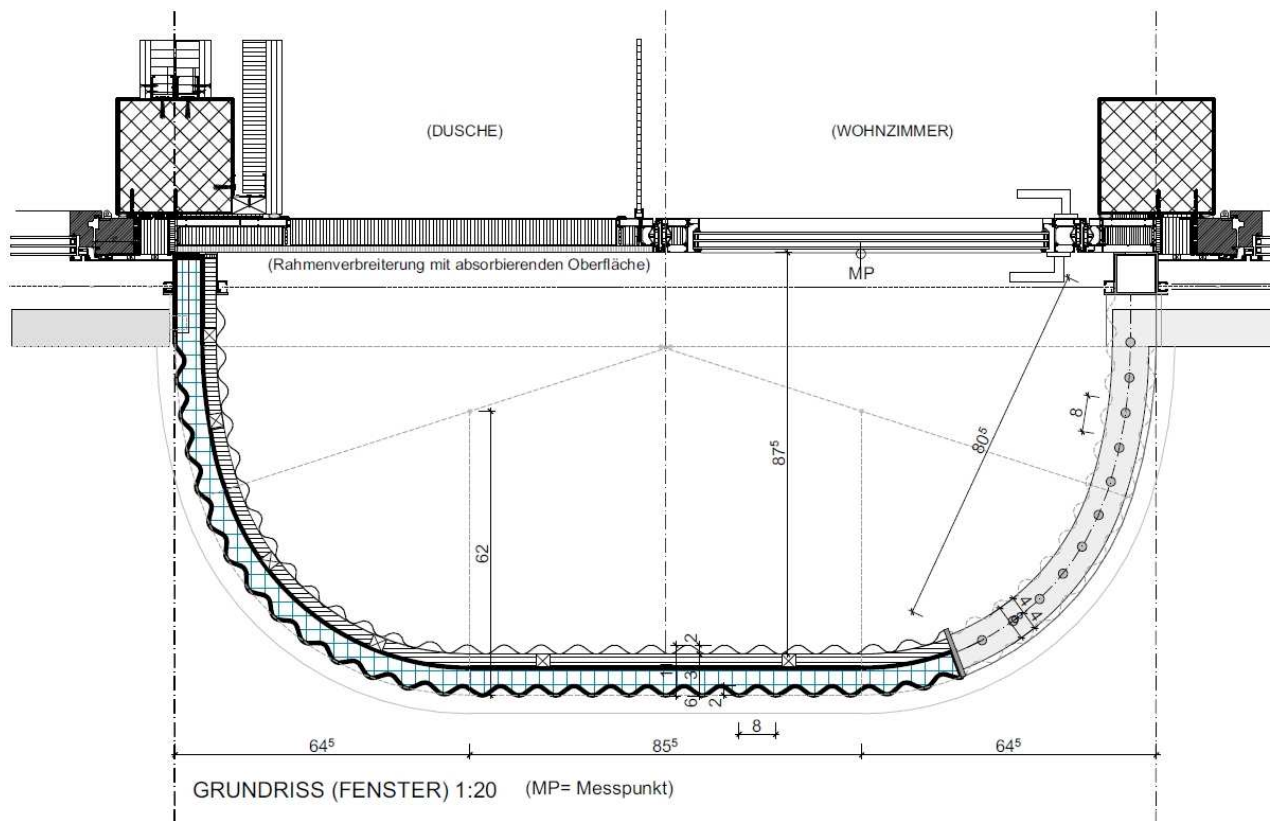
Grundriss Erkertyp 2 bzw. 3.
